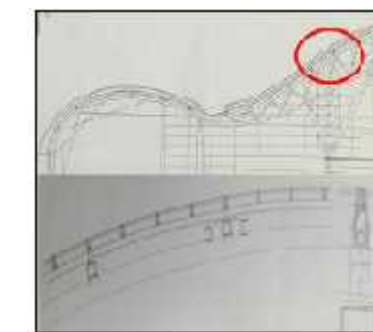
assemblage de poutre triangulée avec la toiture ondulé
